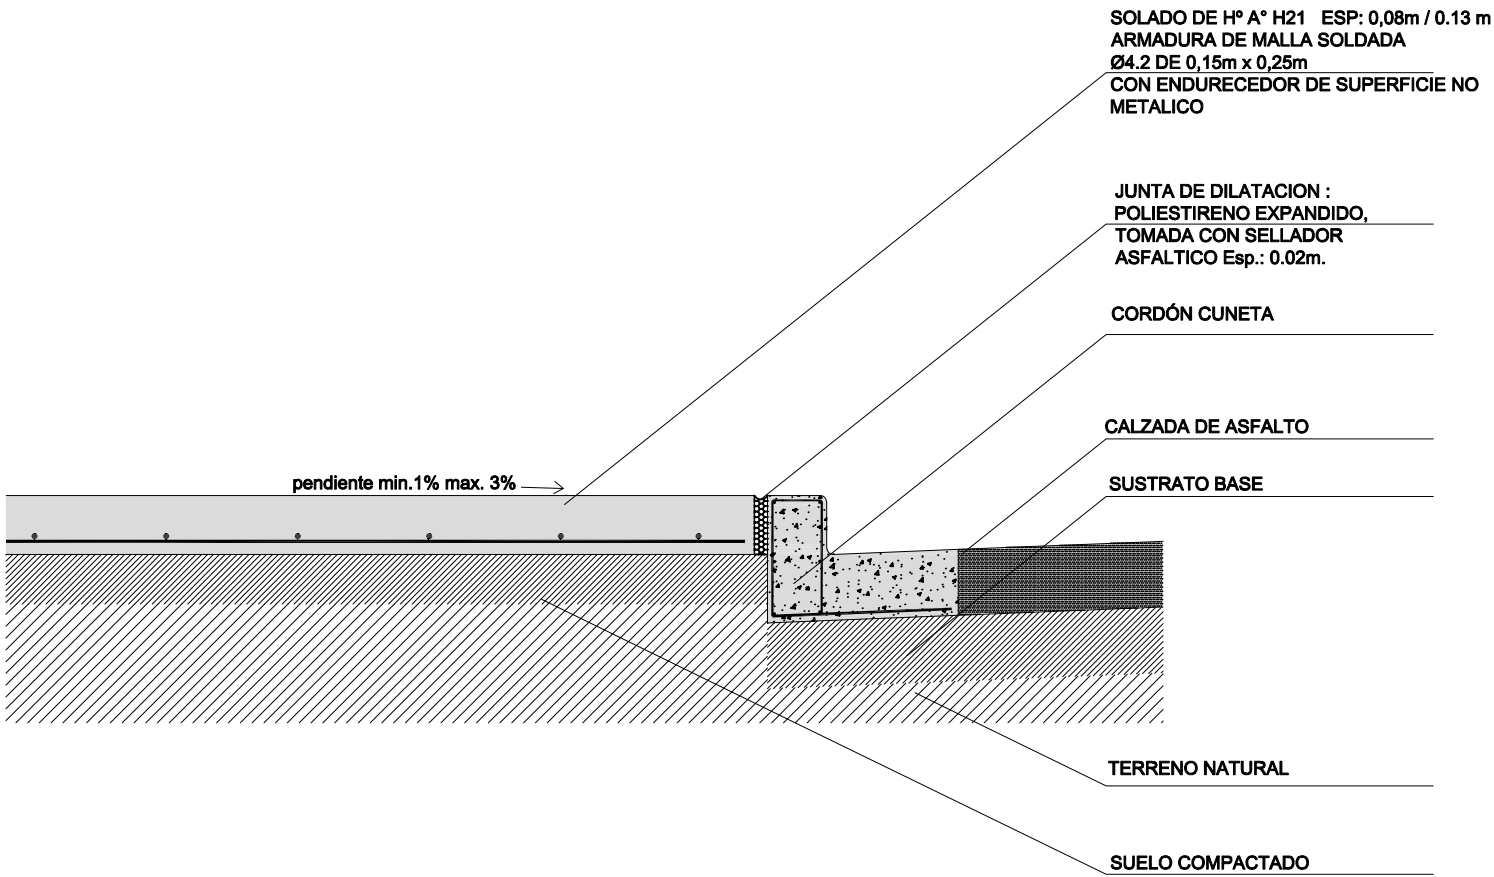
DETALLE DE SOLADO DE HORMIGÓN ARMADO H30
